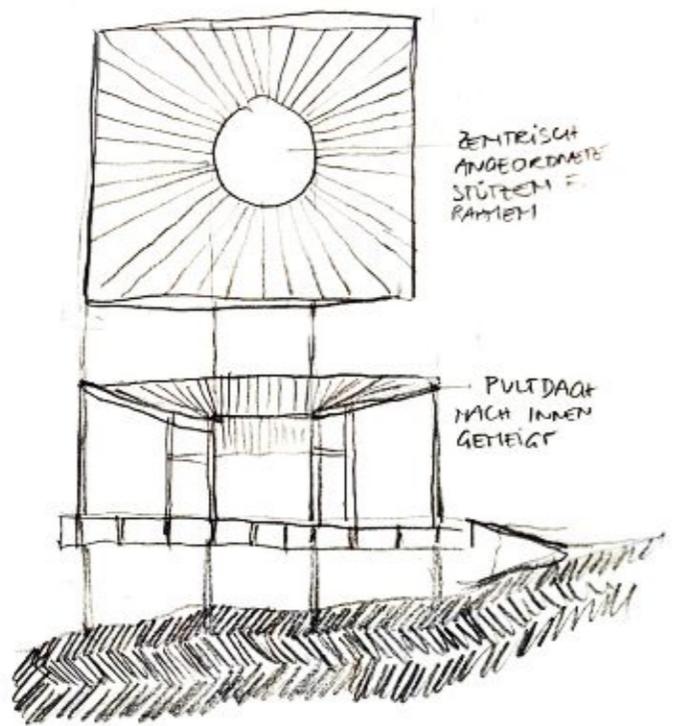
Pfetten-Sparren: Konstruktionsskizze
